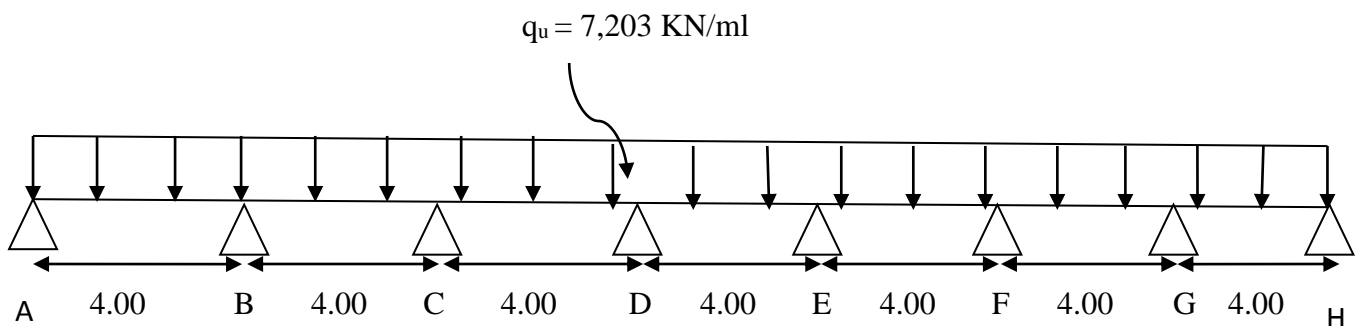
Schéma statique de la poutre continue reposant sur 7 appuis.
